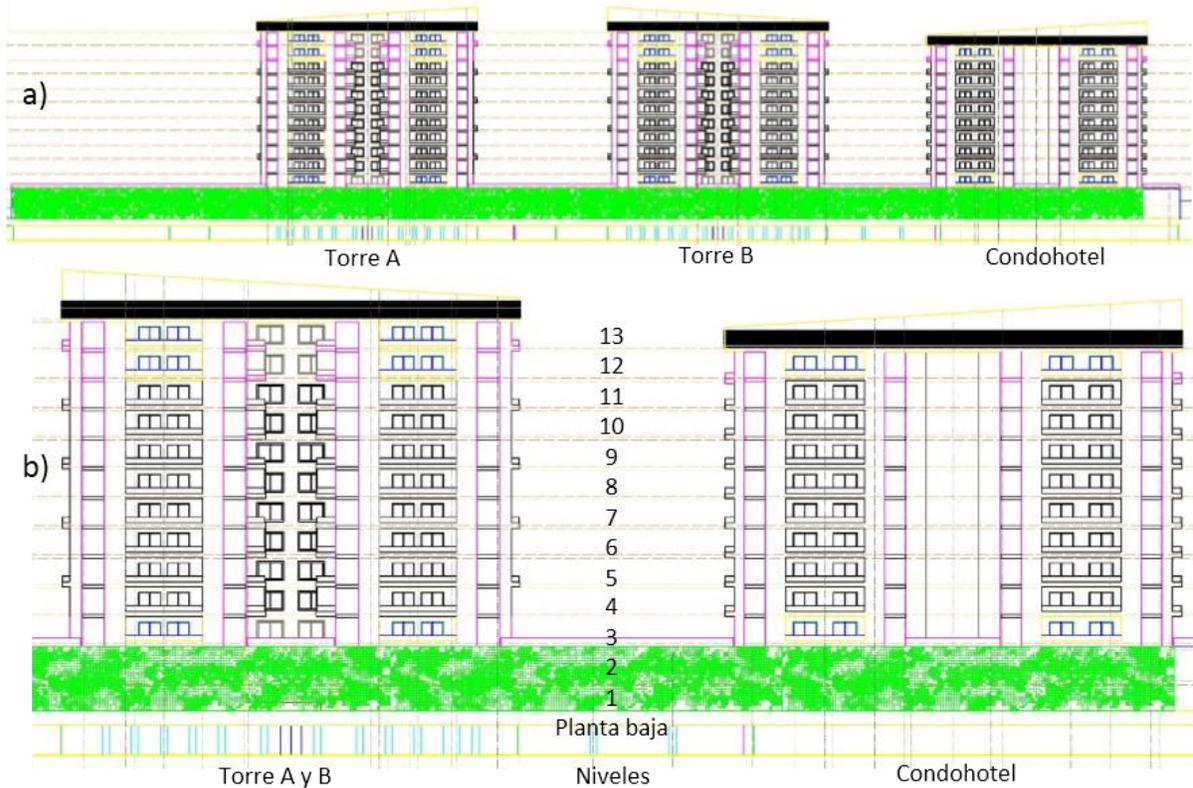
Corte fachada este del proyecto, sobre el Boulevard Kukulcán; b) corte fachada este de torres residenciales (izquierda) y condohotel (derecha)
